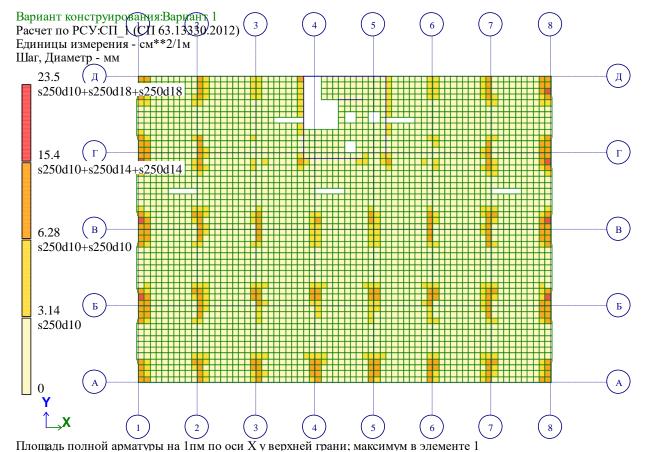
Расчетное армирование плиты покрытия по оси X у верхней грани.
